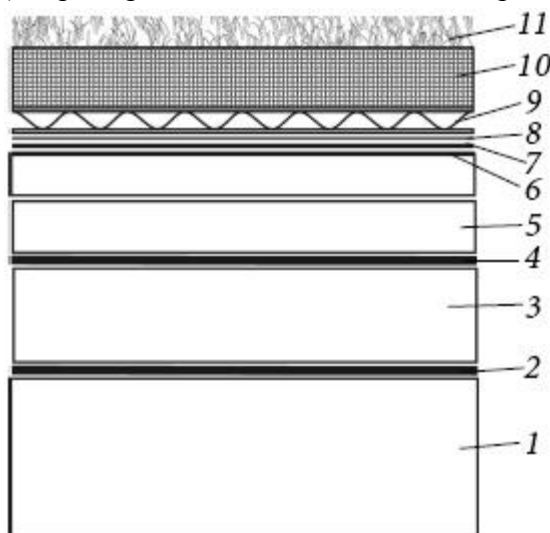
Совмещенная «зеленая» кровля: 1) плита перекрытия; 2) гидроизоляция; 3) утеплитель; 4) разделительный слой картона; 5) стяжка с образованием уклона (разуклонка); 6) слой прочной гидроизоляции; 7) слой гидроизоляции для озелененных крыш; 8) полиэтиленовая пленка; 9) дренажная мембрана между двумя слоями геотекстиля; 10) грунт; 11) озеленение
